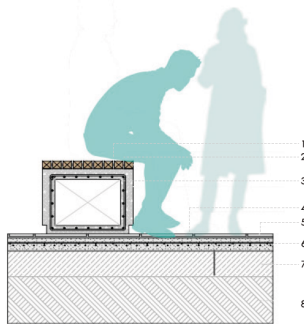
Detalles y secciones de accesibilidad del anteproyecto Parque Purcay
